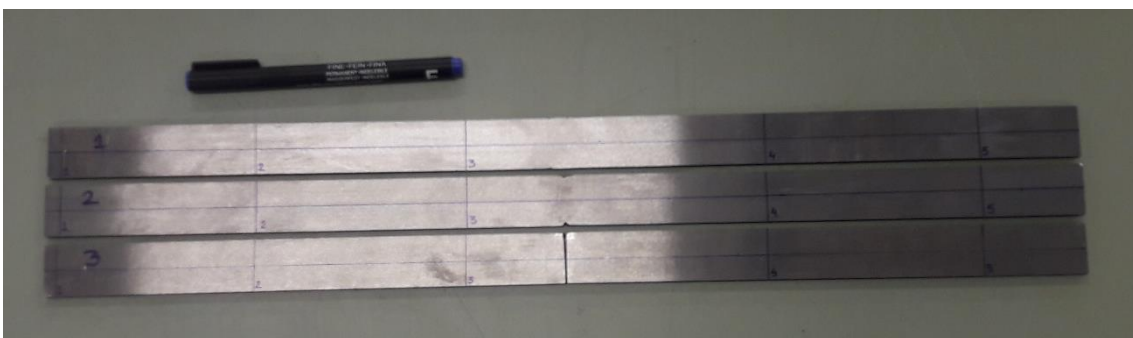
Novas vigas, viga 1-B, 2-B e 3-B
